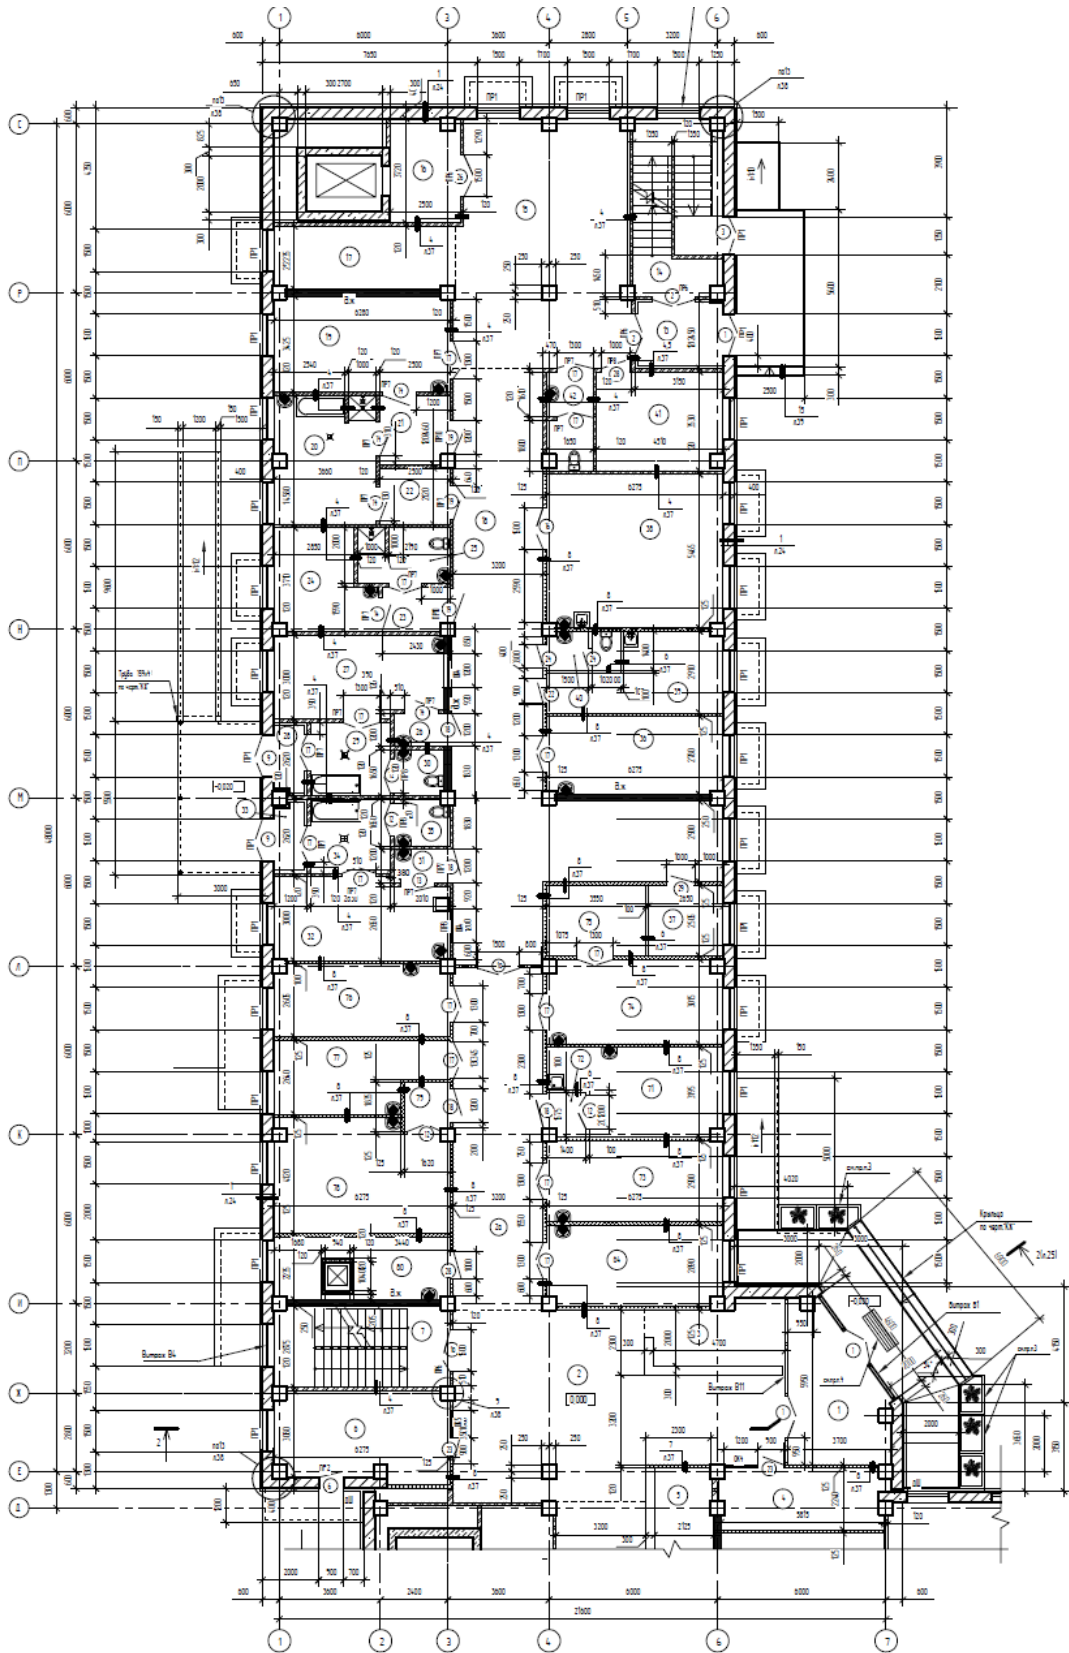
Креслення другої частини 1-6 -го поверхів госпіталю для
